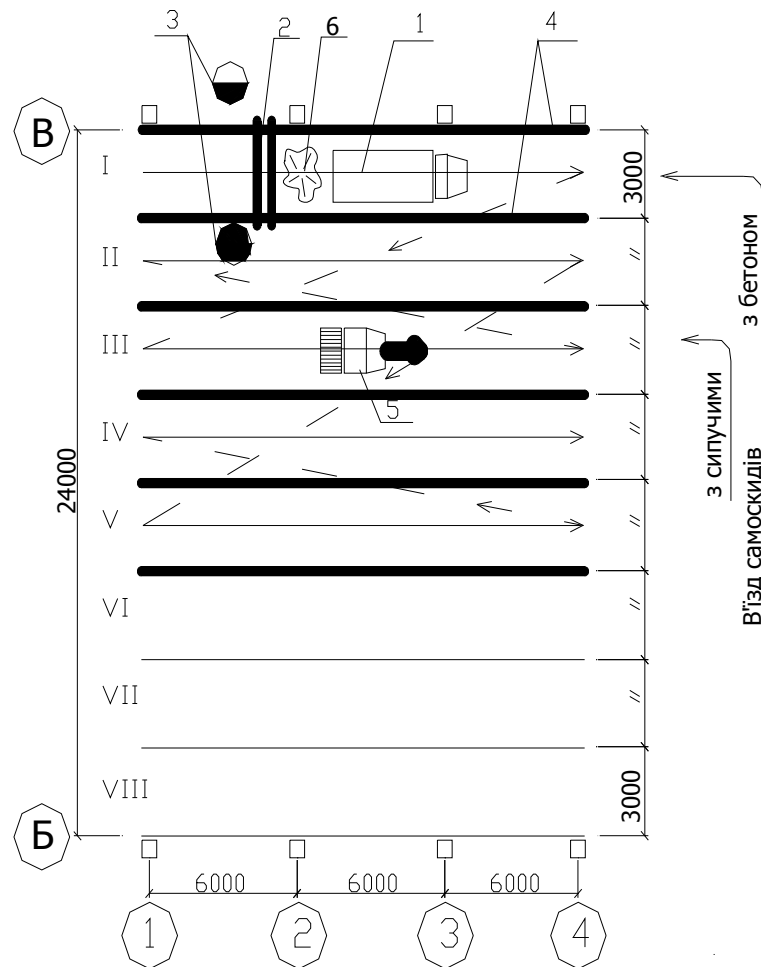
Схема виконання робіт по улаштуванню підстилаючого шару із бетону:
